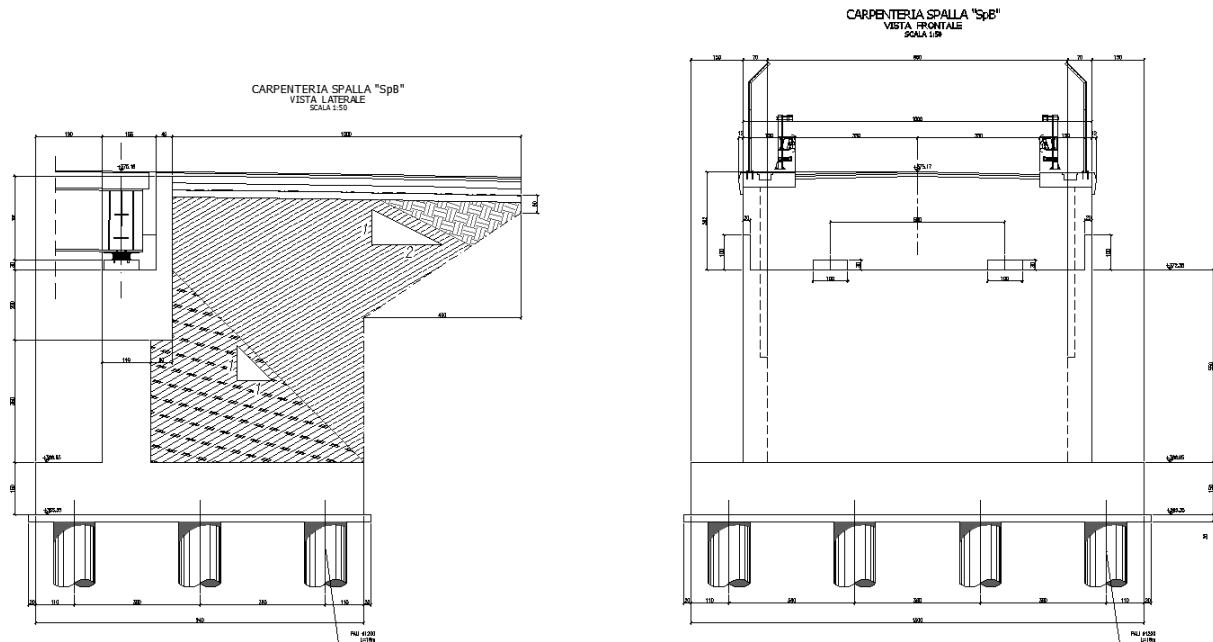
Sezione e prospetto spalla B.
